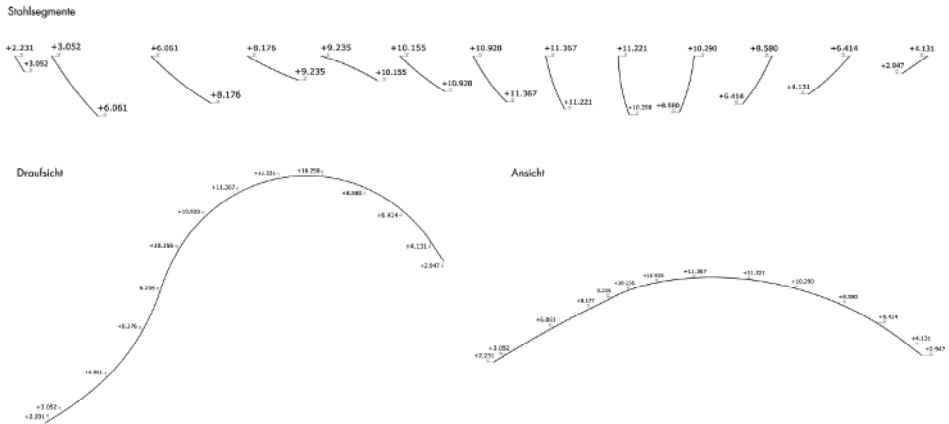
Segmentierung des Stahlrundhohlprofils
